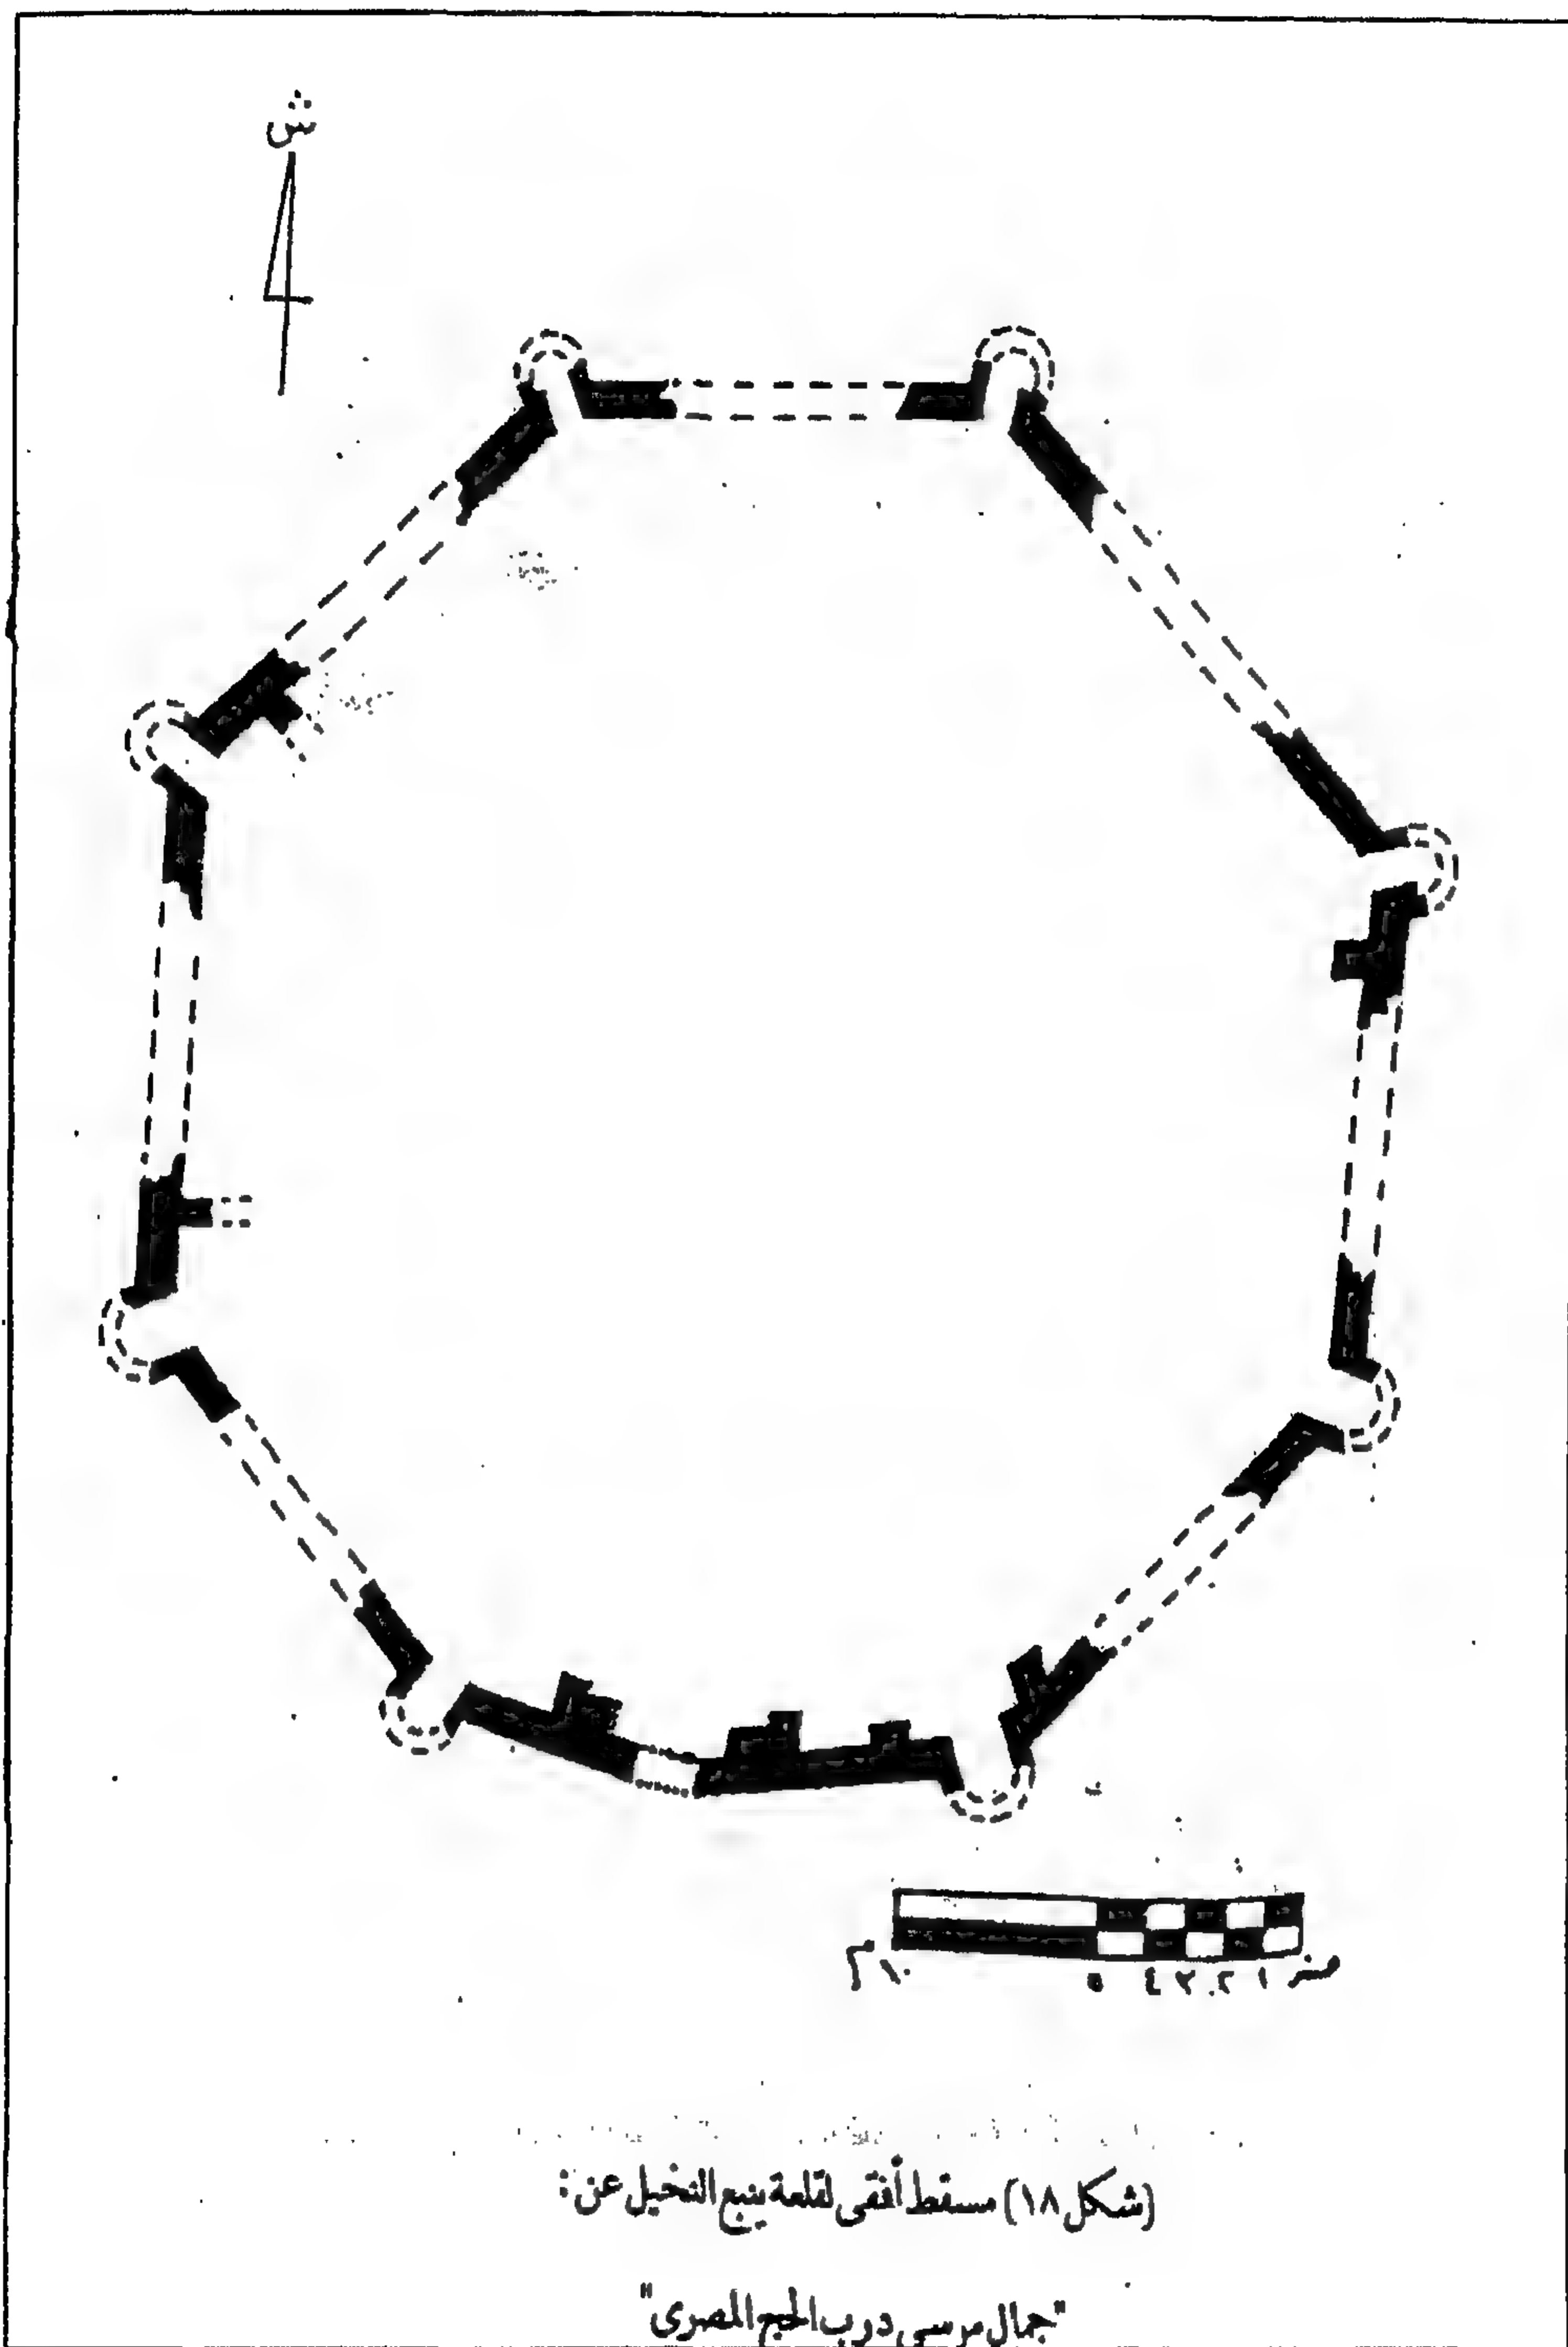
مسقط أفقي للقاعة شعاع عن:
